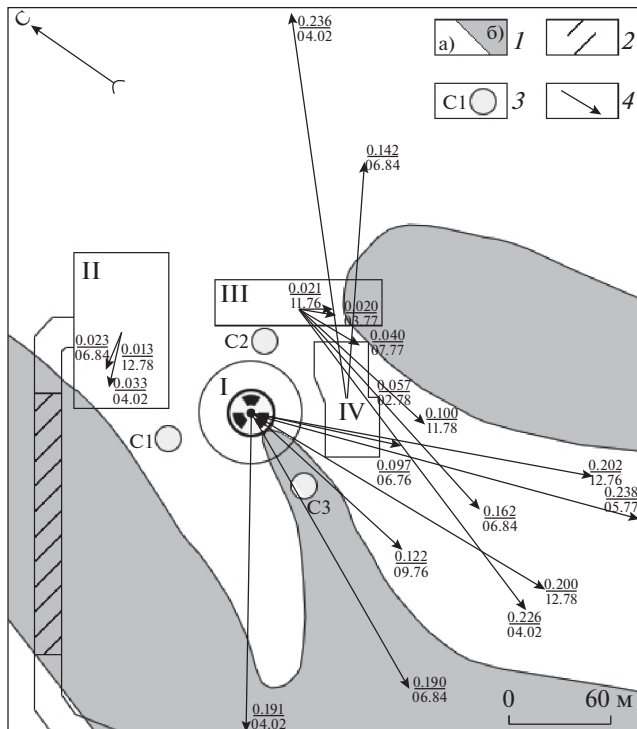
Осадки фундаментов основных зданий АЭС “Бушер”. 1 – грунты: а) с ненарушенным сложением, б) относительно нарушенные (разуплотненные); 2 – участок деформации железобетонного трубопровода; 3 – скважины для вертикального сейсмопрофилирования (ВСП). Основные здания АЭС: I – реакторное отделение № 1, II – машинный зал, III – спецкорпус, IV – здание приема и переработки отработанного ядерного топлива; 4 – направление кренов (стрелки); цифры: в числителе – значения крена относительно критической величины, равной 1; в знаменателе – месяц и год измерений.
